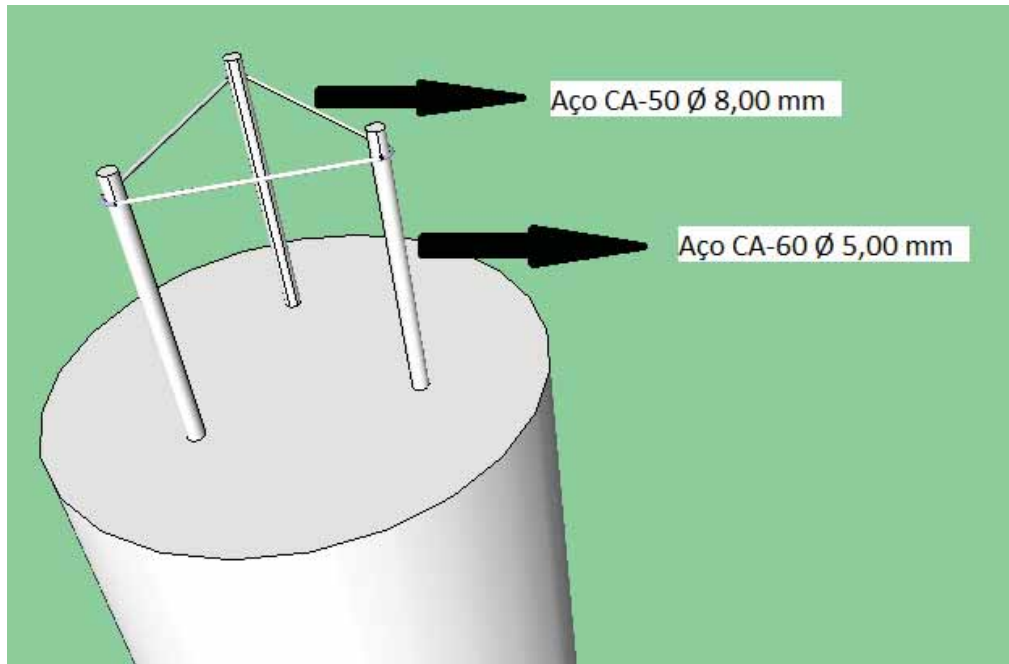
Armadura utilizada nas brocas (Fonte: do autor)
